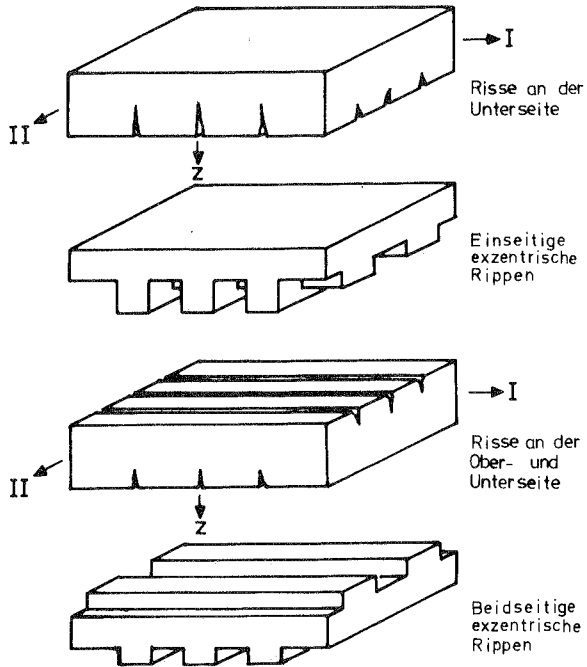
Analogie zwischen gerissenen Stahlbetonplatten und konstruktiv orthotropen Platten
